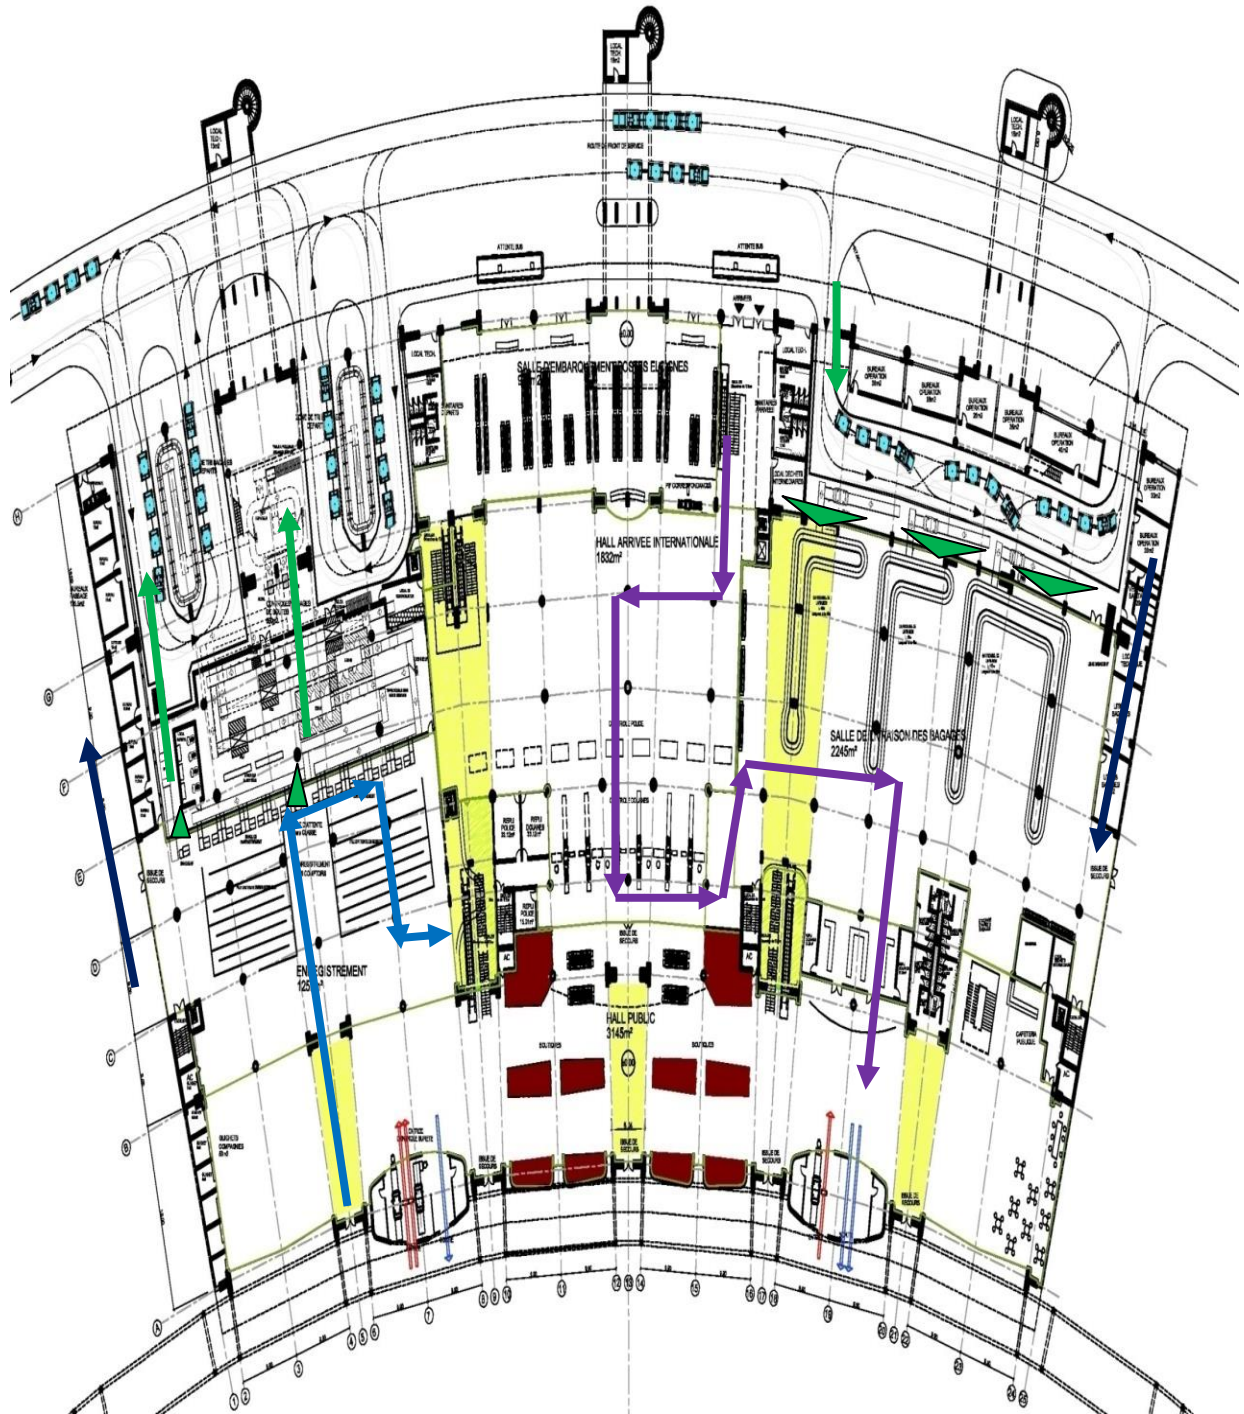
Cheminement passagers et bagages -Plan du rez-de-chaussée
